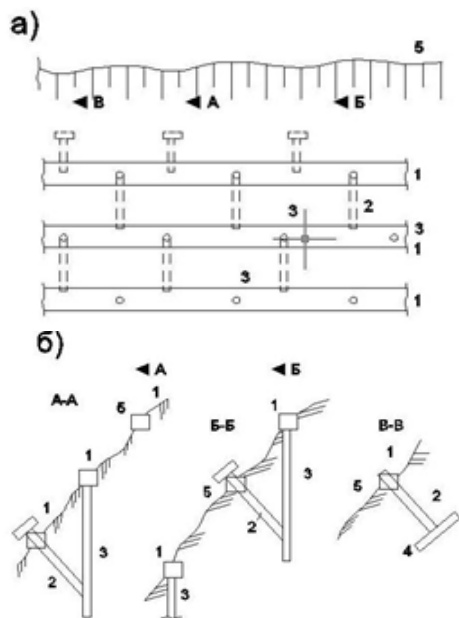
Пальово-анкерна споруда: а – трирядове розташування паль; б – розрізи по А-А; Б-Б; В-В; 1 – ростверк – пояс; 2 – нахилений залізобетонний анкер; 3 – буронабивні палі; 4 – анкерна плита, 5 – поверхня схилу
